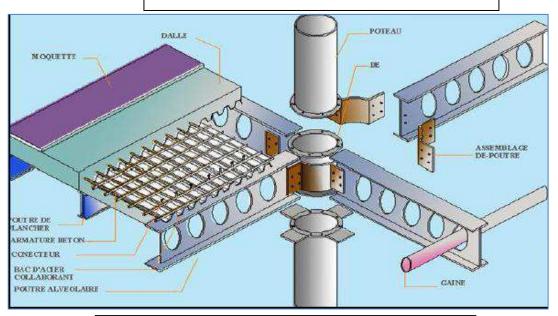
schéma de jonction plancher-ossature Source : les auteurs
